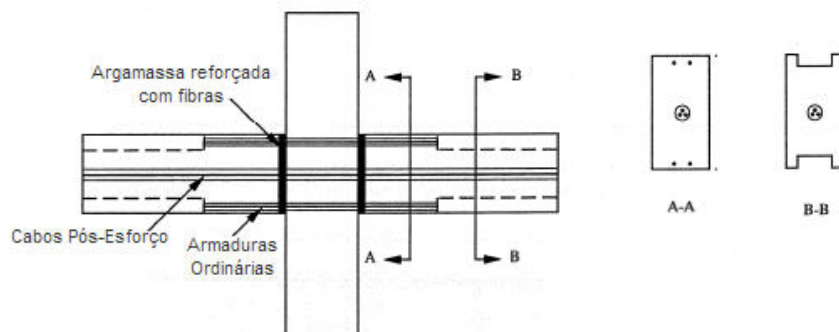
Pormenores da ligação híbrida (adaptada de [26])
